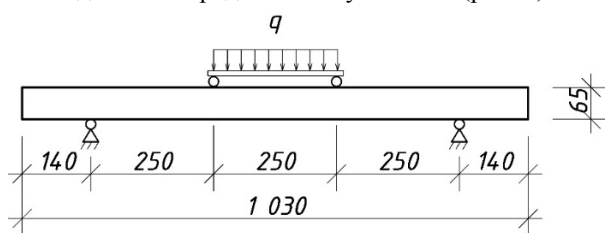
Схема завантаження випробовуваних залізобетонних балок
